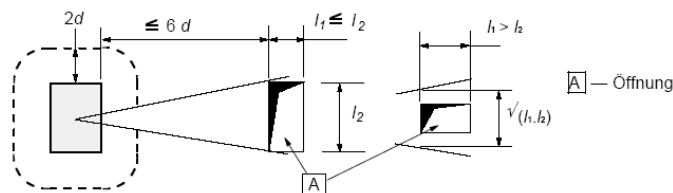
Rundschnitte in der Nähe von Öffnungen
